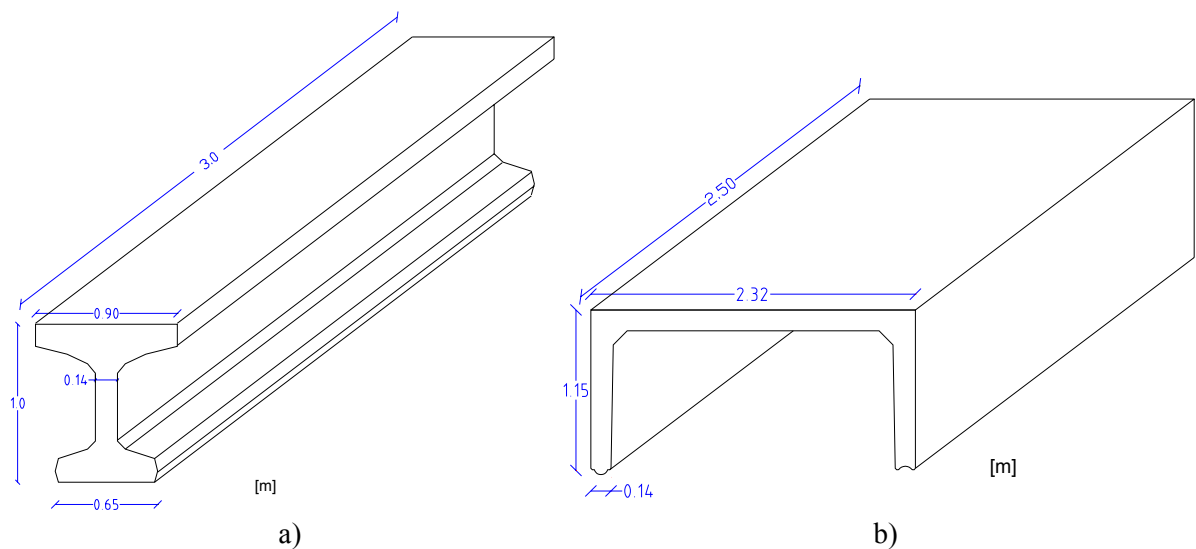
Dimensões das peças betonadas durante o ensaio à escala real: a) troço de viga I; b) box-culvert
